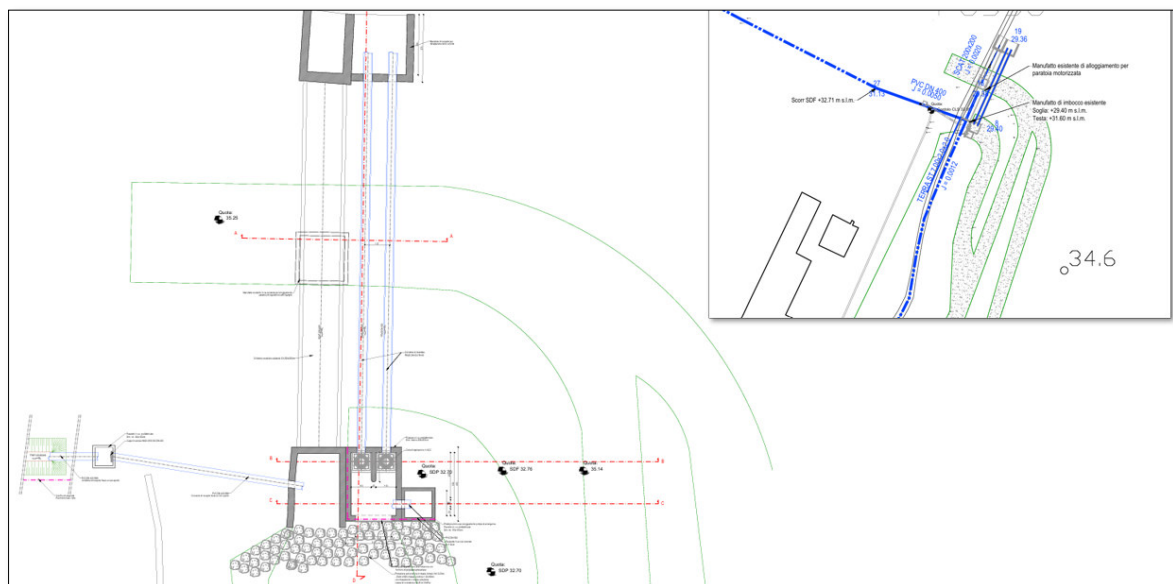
Sezione orizzontale dell'impianto di sollevamento elettromeccanico (documentazione fornita dalla Committenza)
